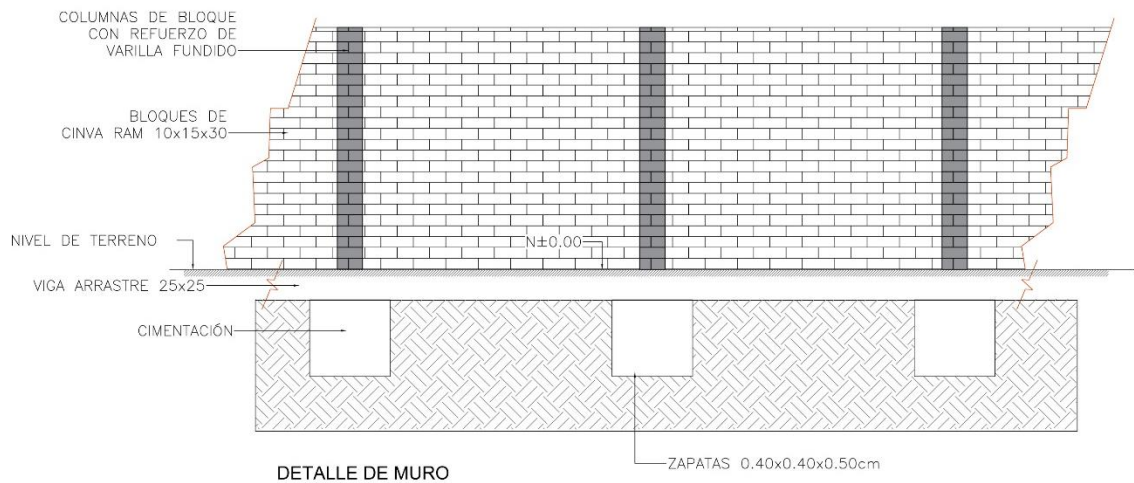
detalle de viga de amarre con muro en ladrillo ecológico reforzado
